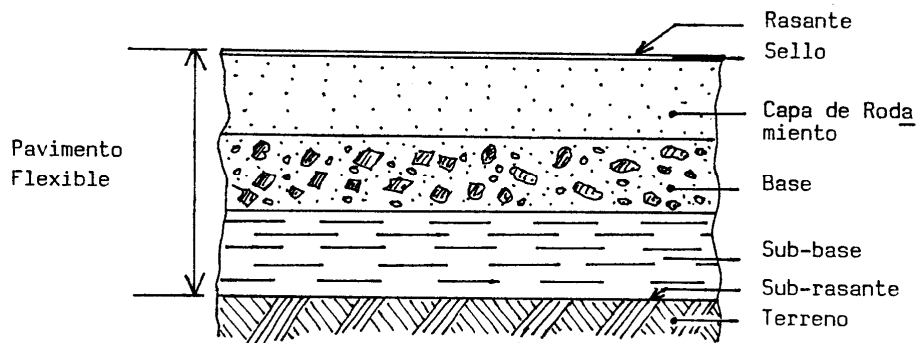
Esquema básico de la estructura de un pavimento flexible
